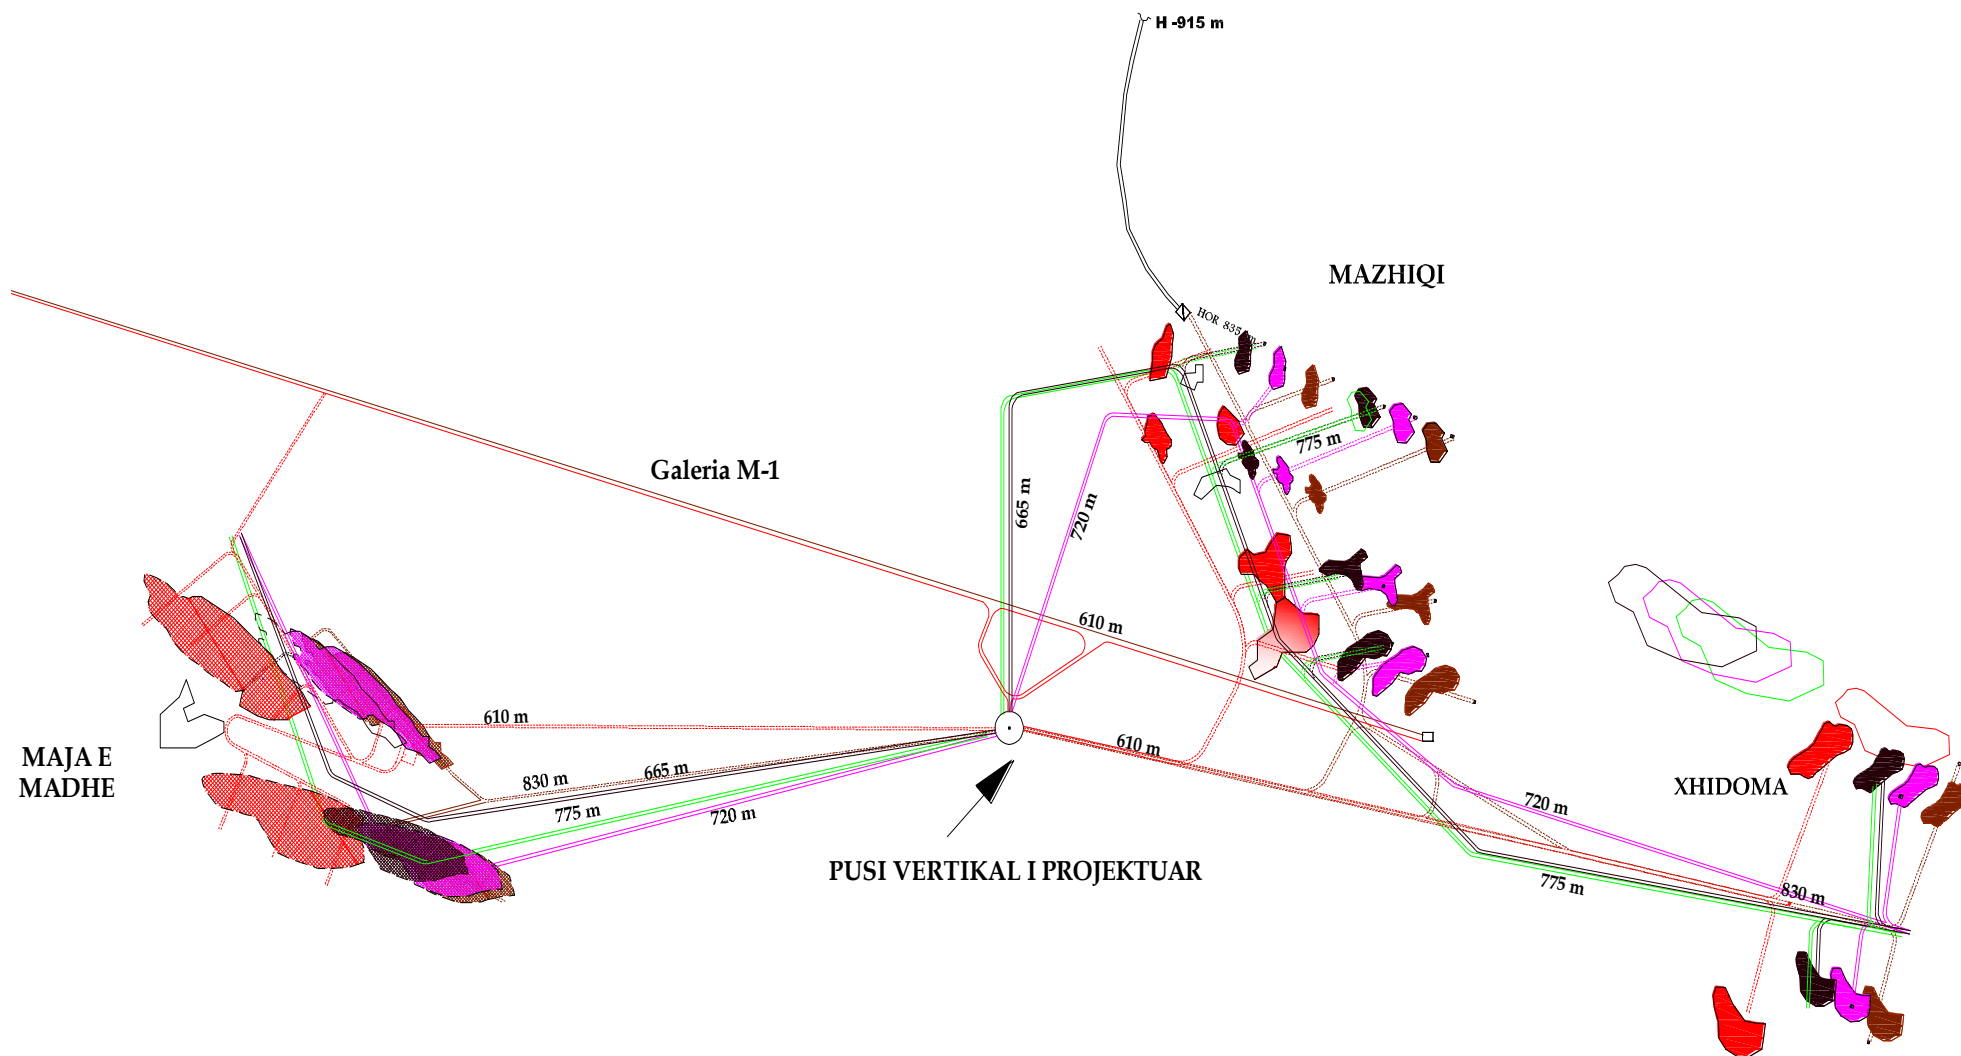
Paraqitja në plan e galerive dhe horizonteve
